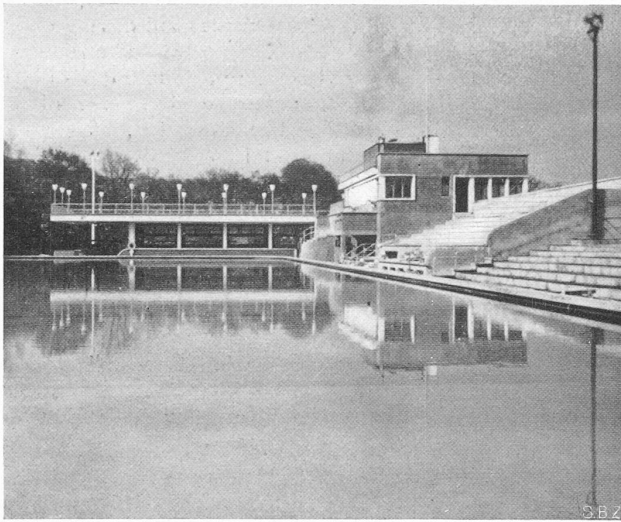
Planschbecken, rechts Tribünen, darunter Garderoben, hinten Restaurant.
